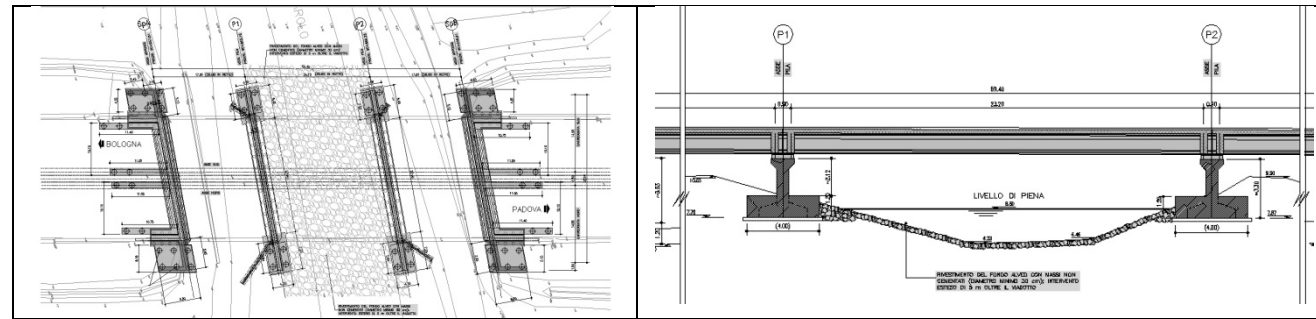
Canale Bagnarolo planimetria e sezione longitudinale
